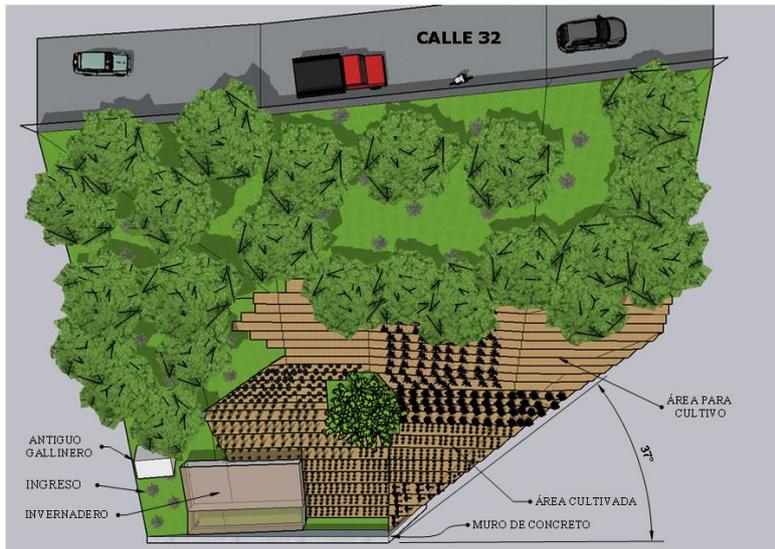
Distribución en planta actual. Vista de Arriba. Fuente: Sketchup
